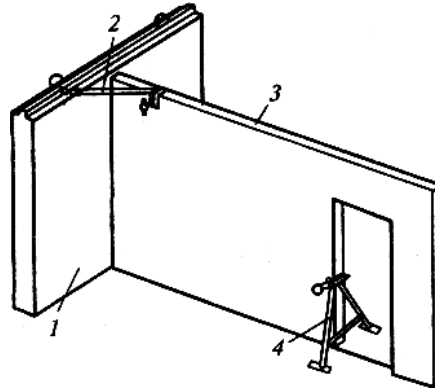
Схема временного крепления панели внутренней стены с помощью монтажной связи и монтажной опоры:
